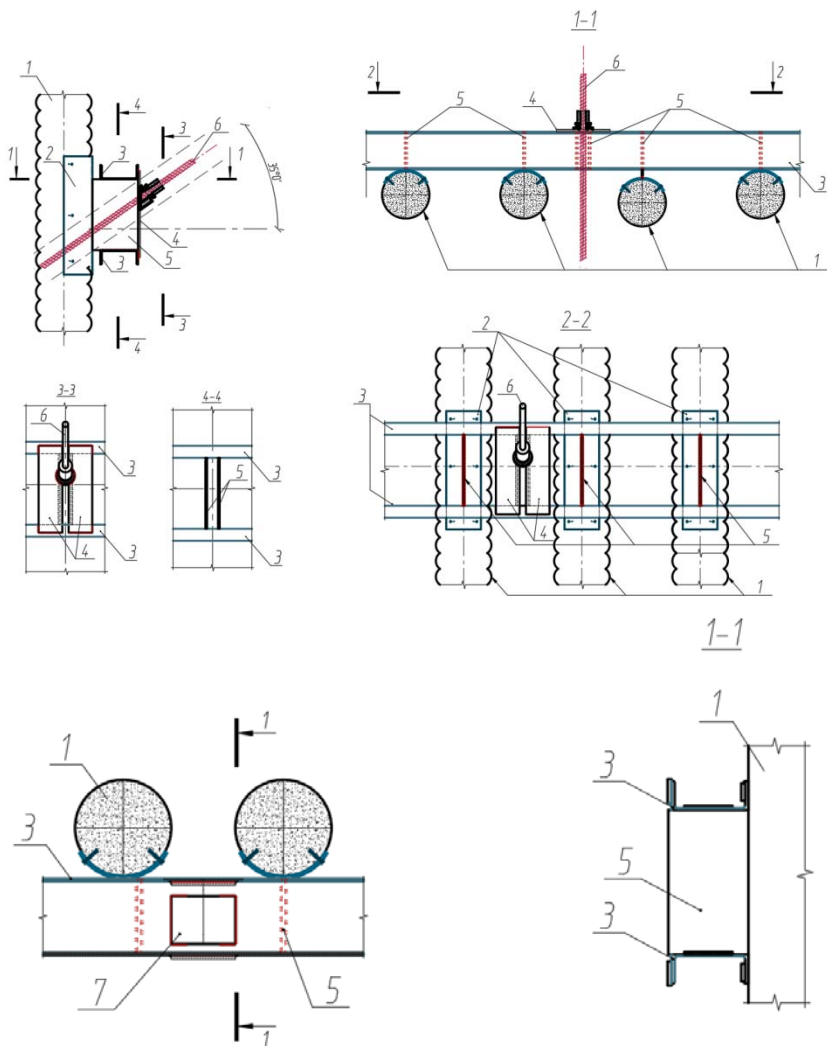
Схема узла крепления грунтовых анкеров к обвязочному поясу: 1 – буринъекционная свая ЭРТ; 2 – упор анкерного пояса; 3 – анкерный пояс из стальных профилей; 4 – стальная пластинка; 5 – ребра жесткости анкерного пояса; 6 – стержень из высокопрочной арматуры анкерного пояса; 7 – узел крепления стыка анкерного пояса
